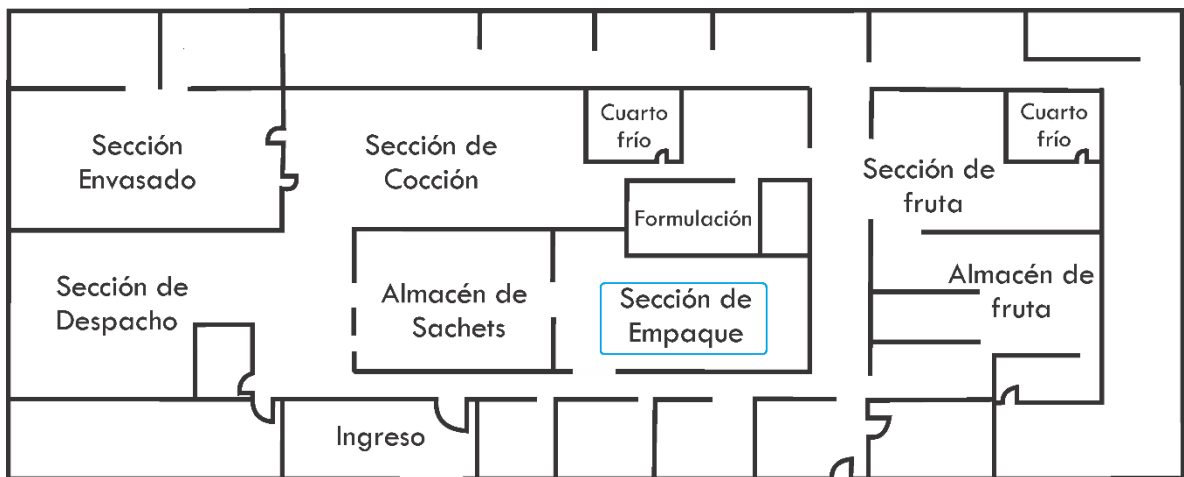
Plano de planta básica, Sección a trabajar resaltada (Fuente propia)
